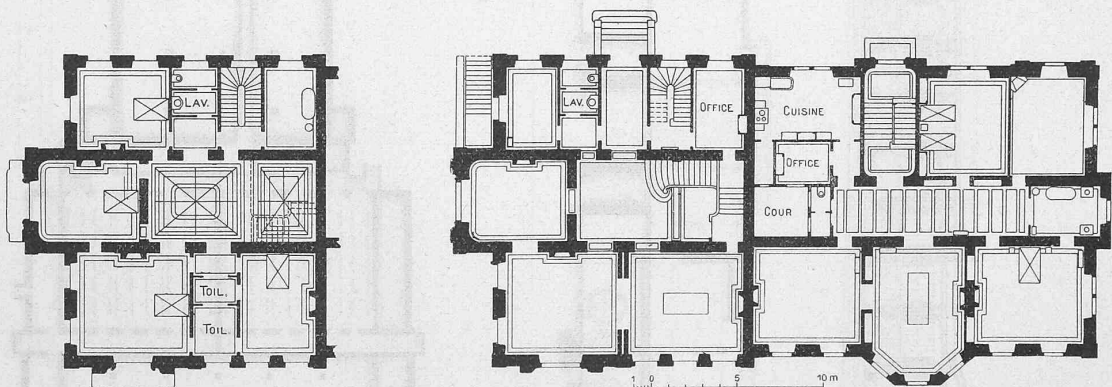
et 12. Pavillons d'habitation. — Plan du rez-de-chaussée et plan du premier étage de l'aile ouest.
